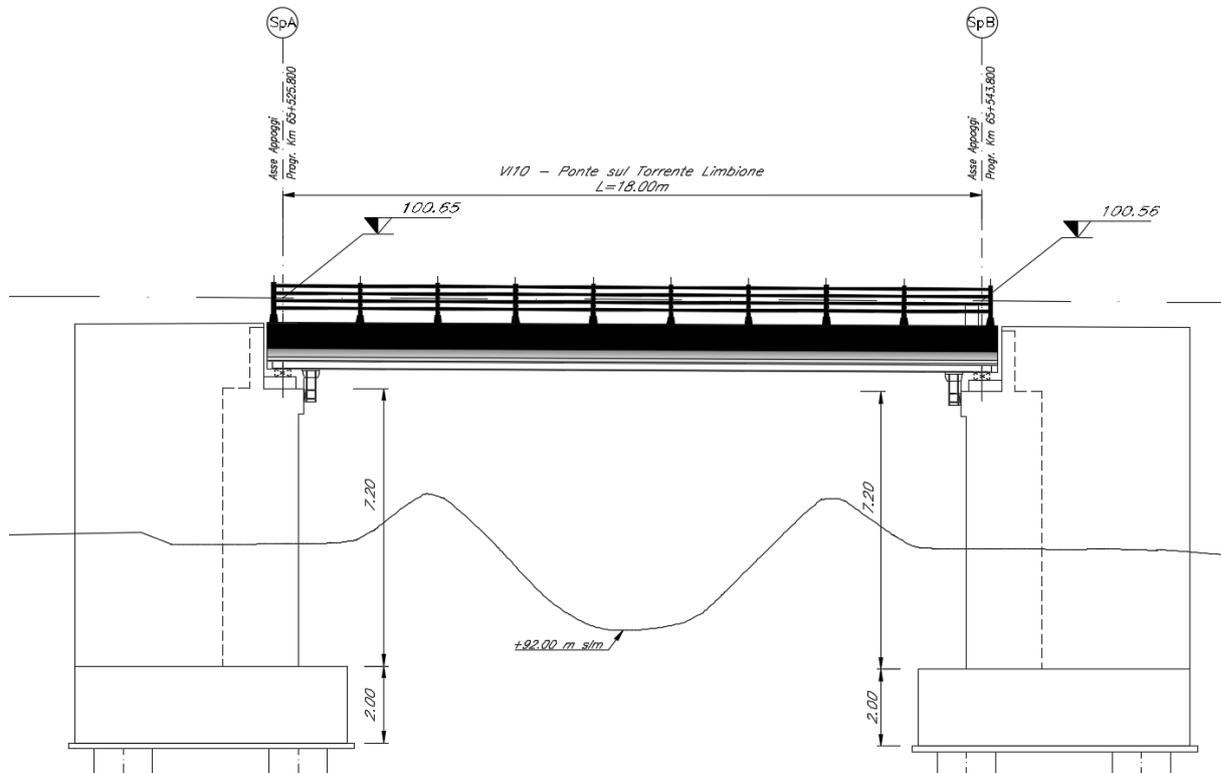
Torrente Limbione: sezione/prospetto dell'opera di attraversamento in progetto.
